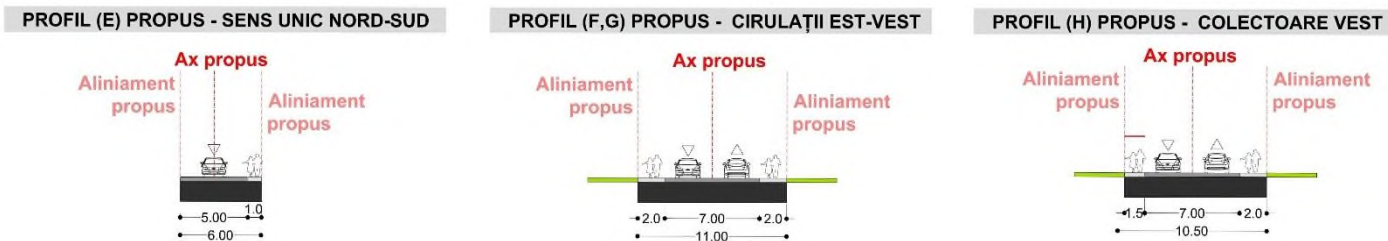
Profile stradale strada Chilieii, strada Panait Cerna și strada Soveja;
